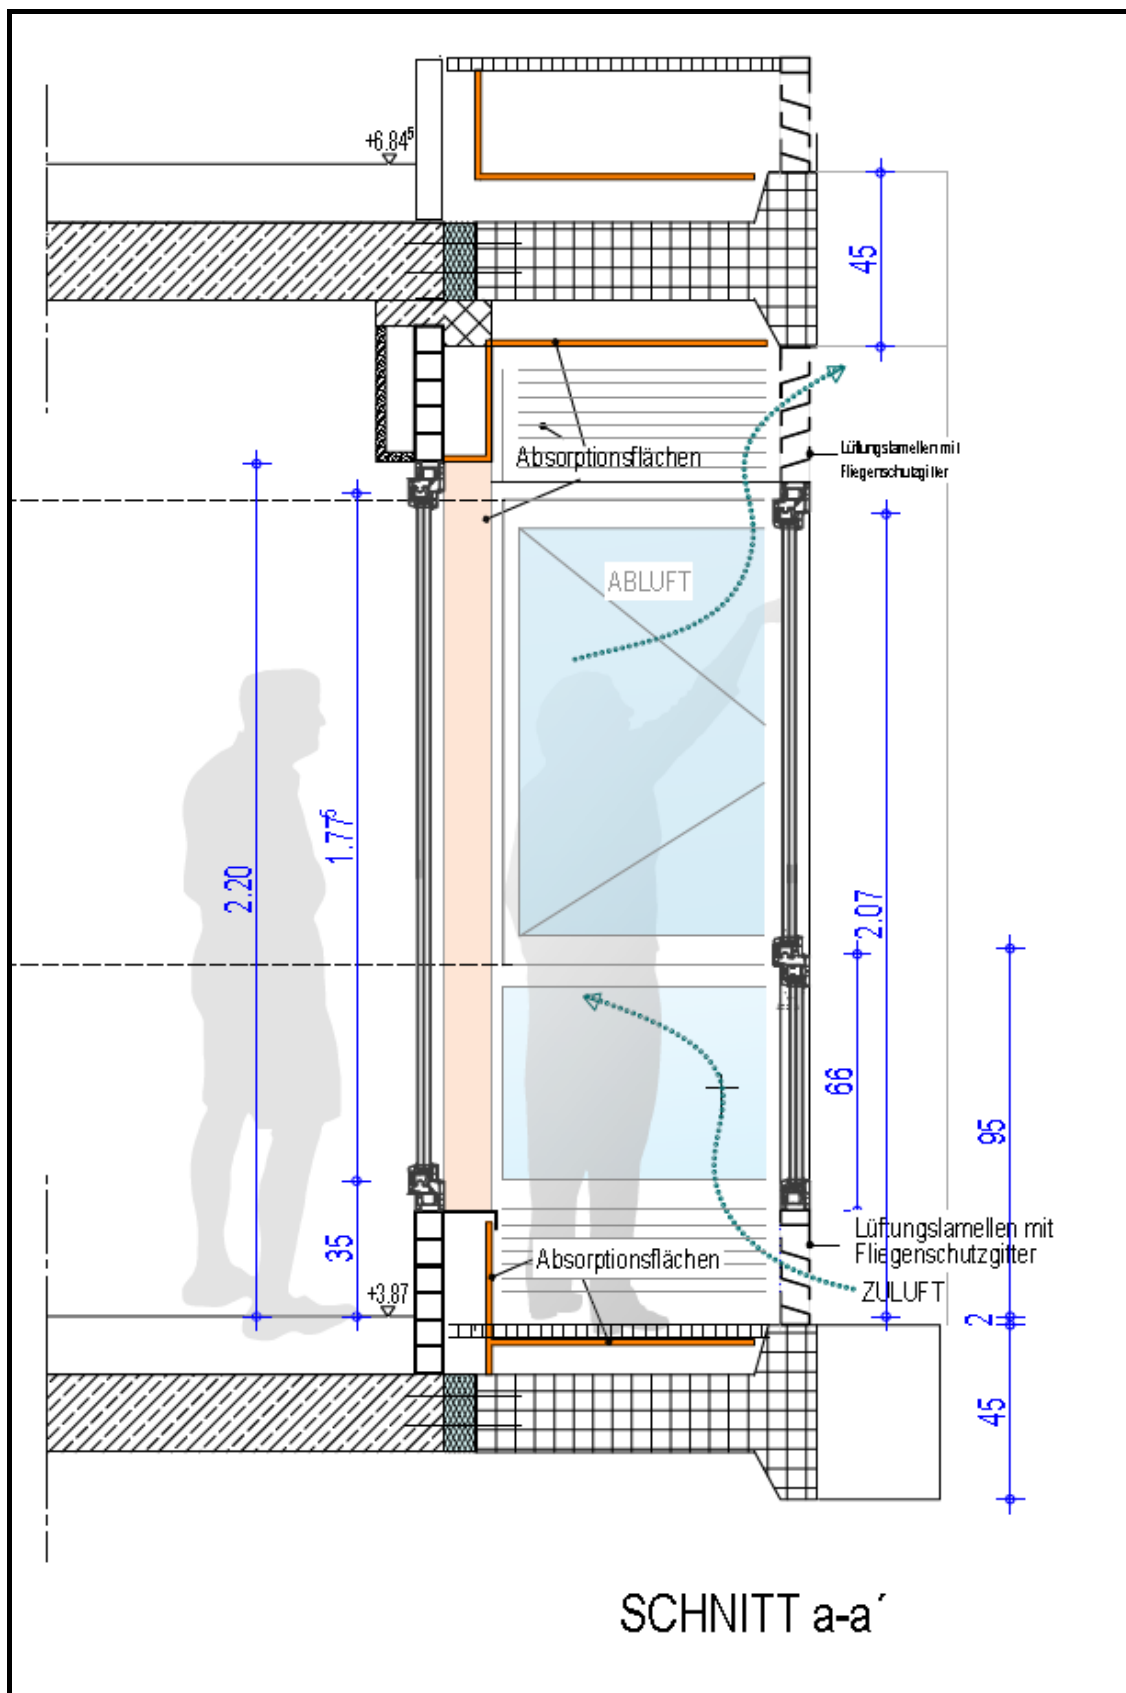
Details der Fensterkonstruktion in Räumen für pflegebedürftige Menschen (Ansicht)
